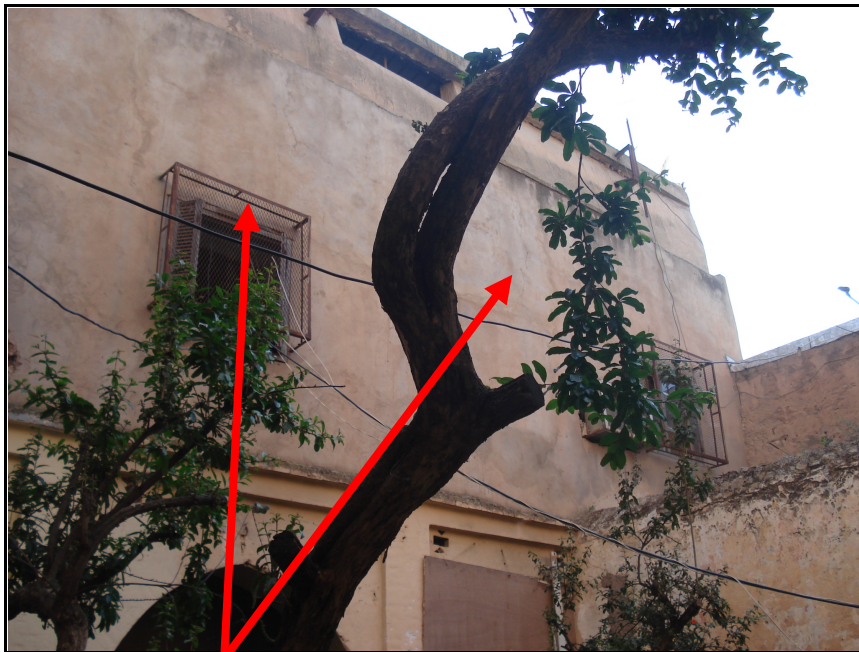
Dégradation du mortier de jointement et éclatement de l'enduit.
